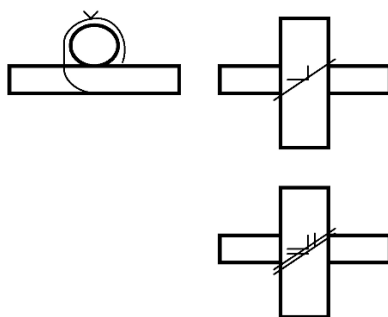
„Einfachschlag“ bei horizontal liegenden Stäben
